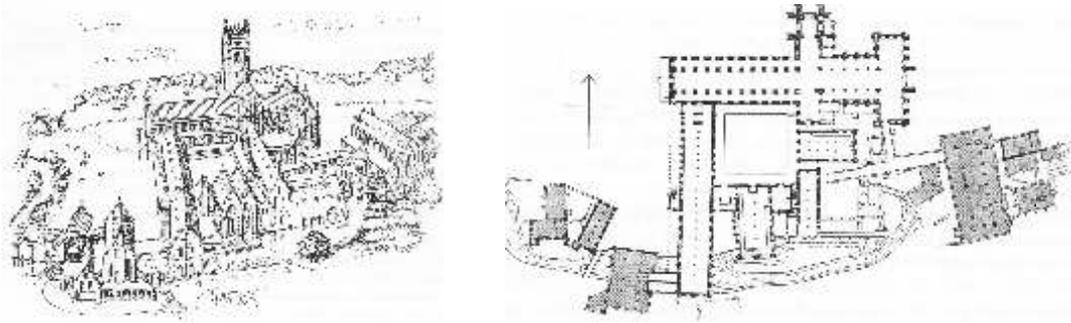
e 2.6 - Perspectiva e planta do Hospital Fountains Abbey, de 1132. Fonte: LEISTIKOW,1967.
